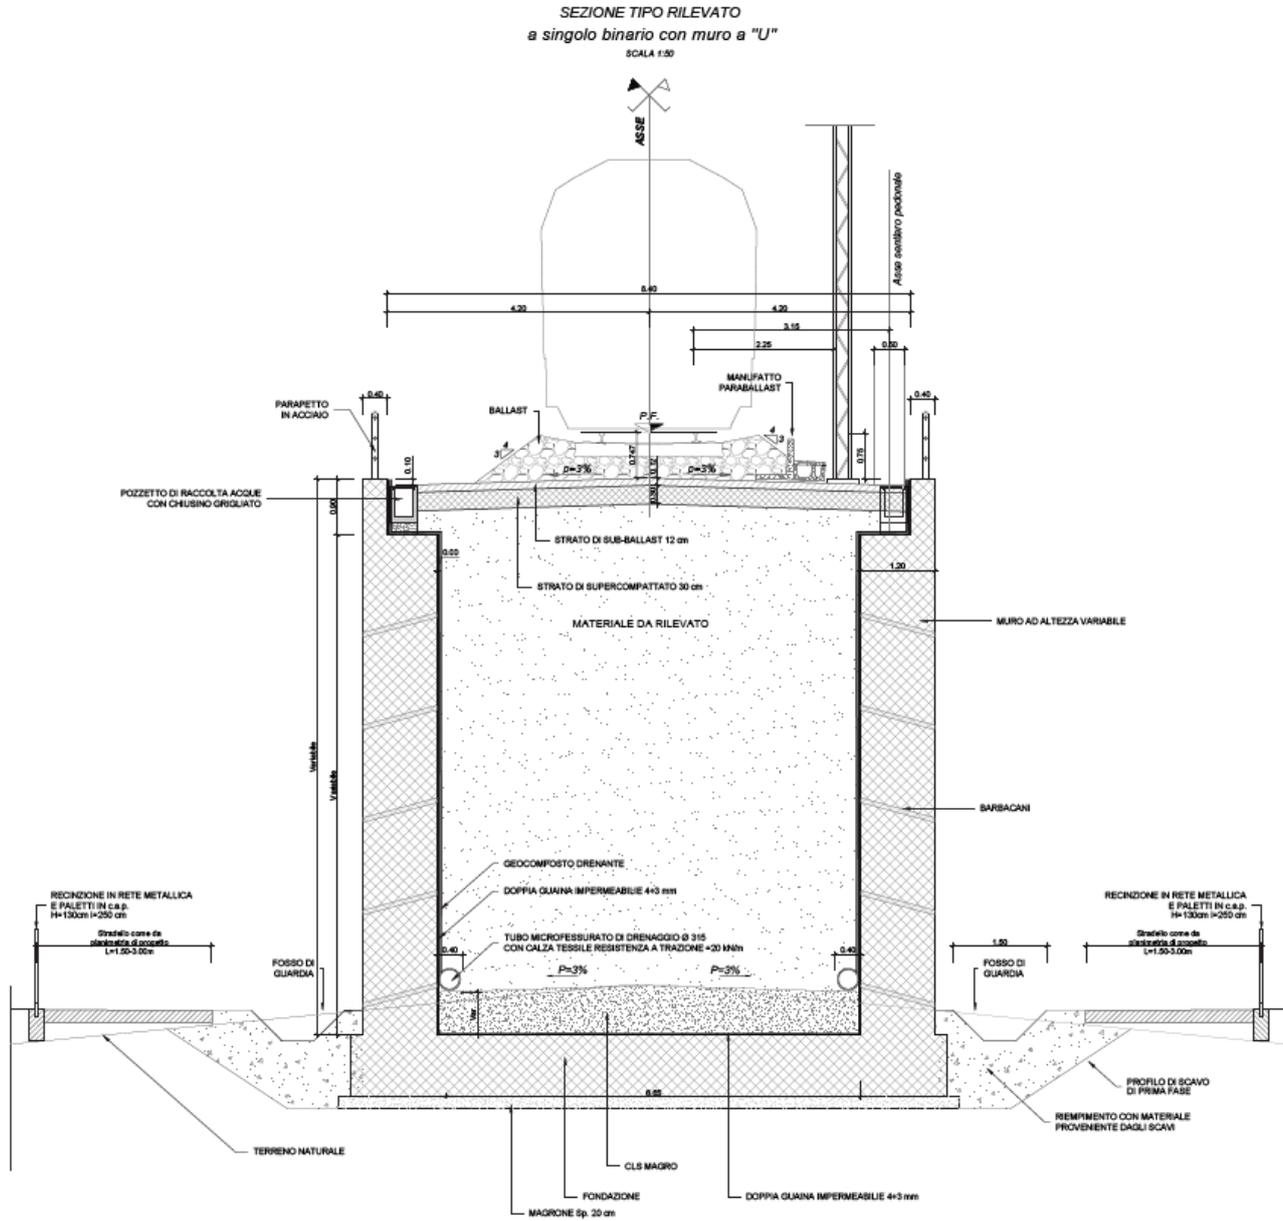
Sezione tipologica Rilevato tra Muri ad U
